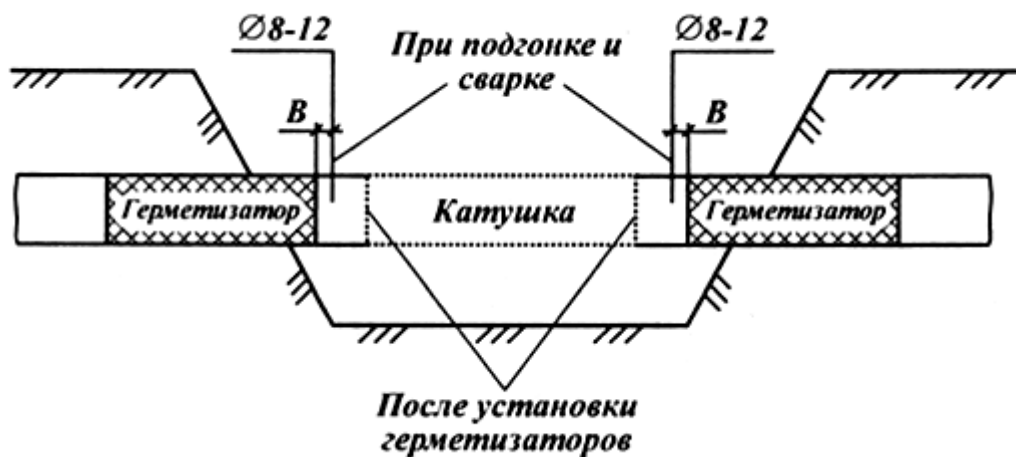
Схема отбора проб при монтаже и сварке «катушки»:
